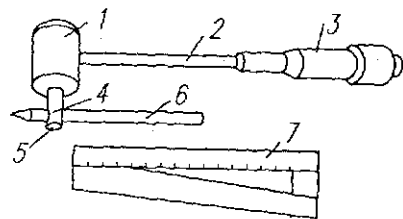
Молоток К.П. Кашкарова: 1 — корпус; 2 — металлическая рукоятка; 3 — резиновая ручка; 4 — головка; 5 — стальной шарик; 6 — стальной эталонный стержень; 7 — угловой масштаб
